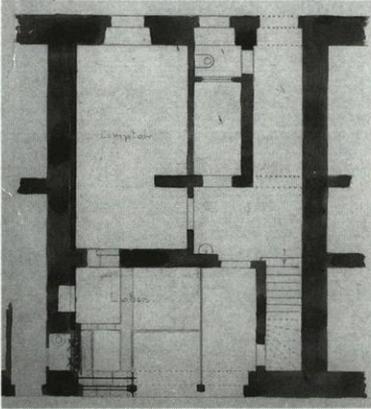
Obermünsterplatz 2, Erdgeschoss, Grundriss 1905 (BOAR).
